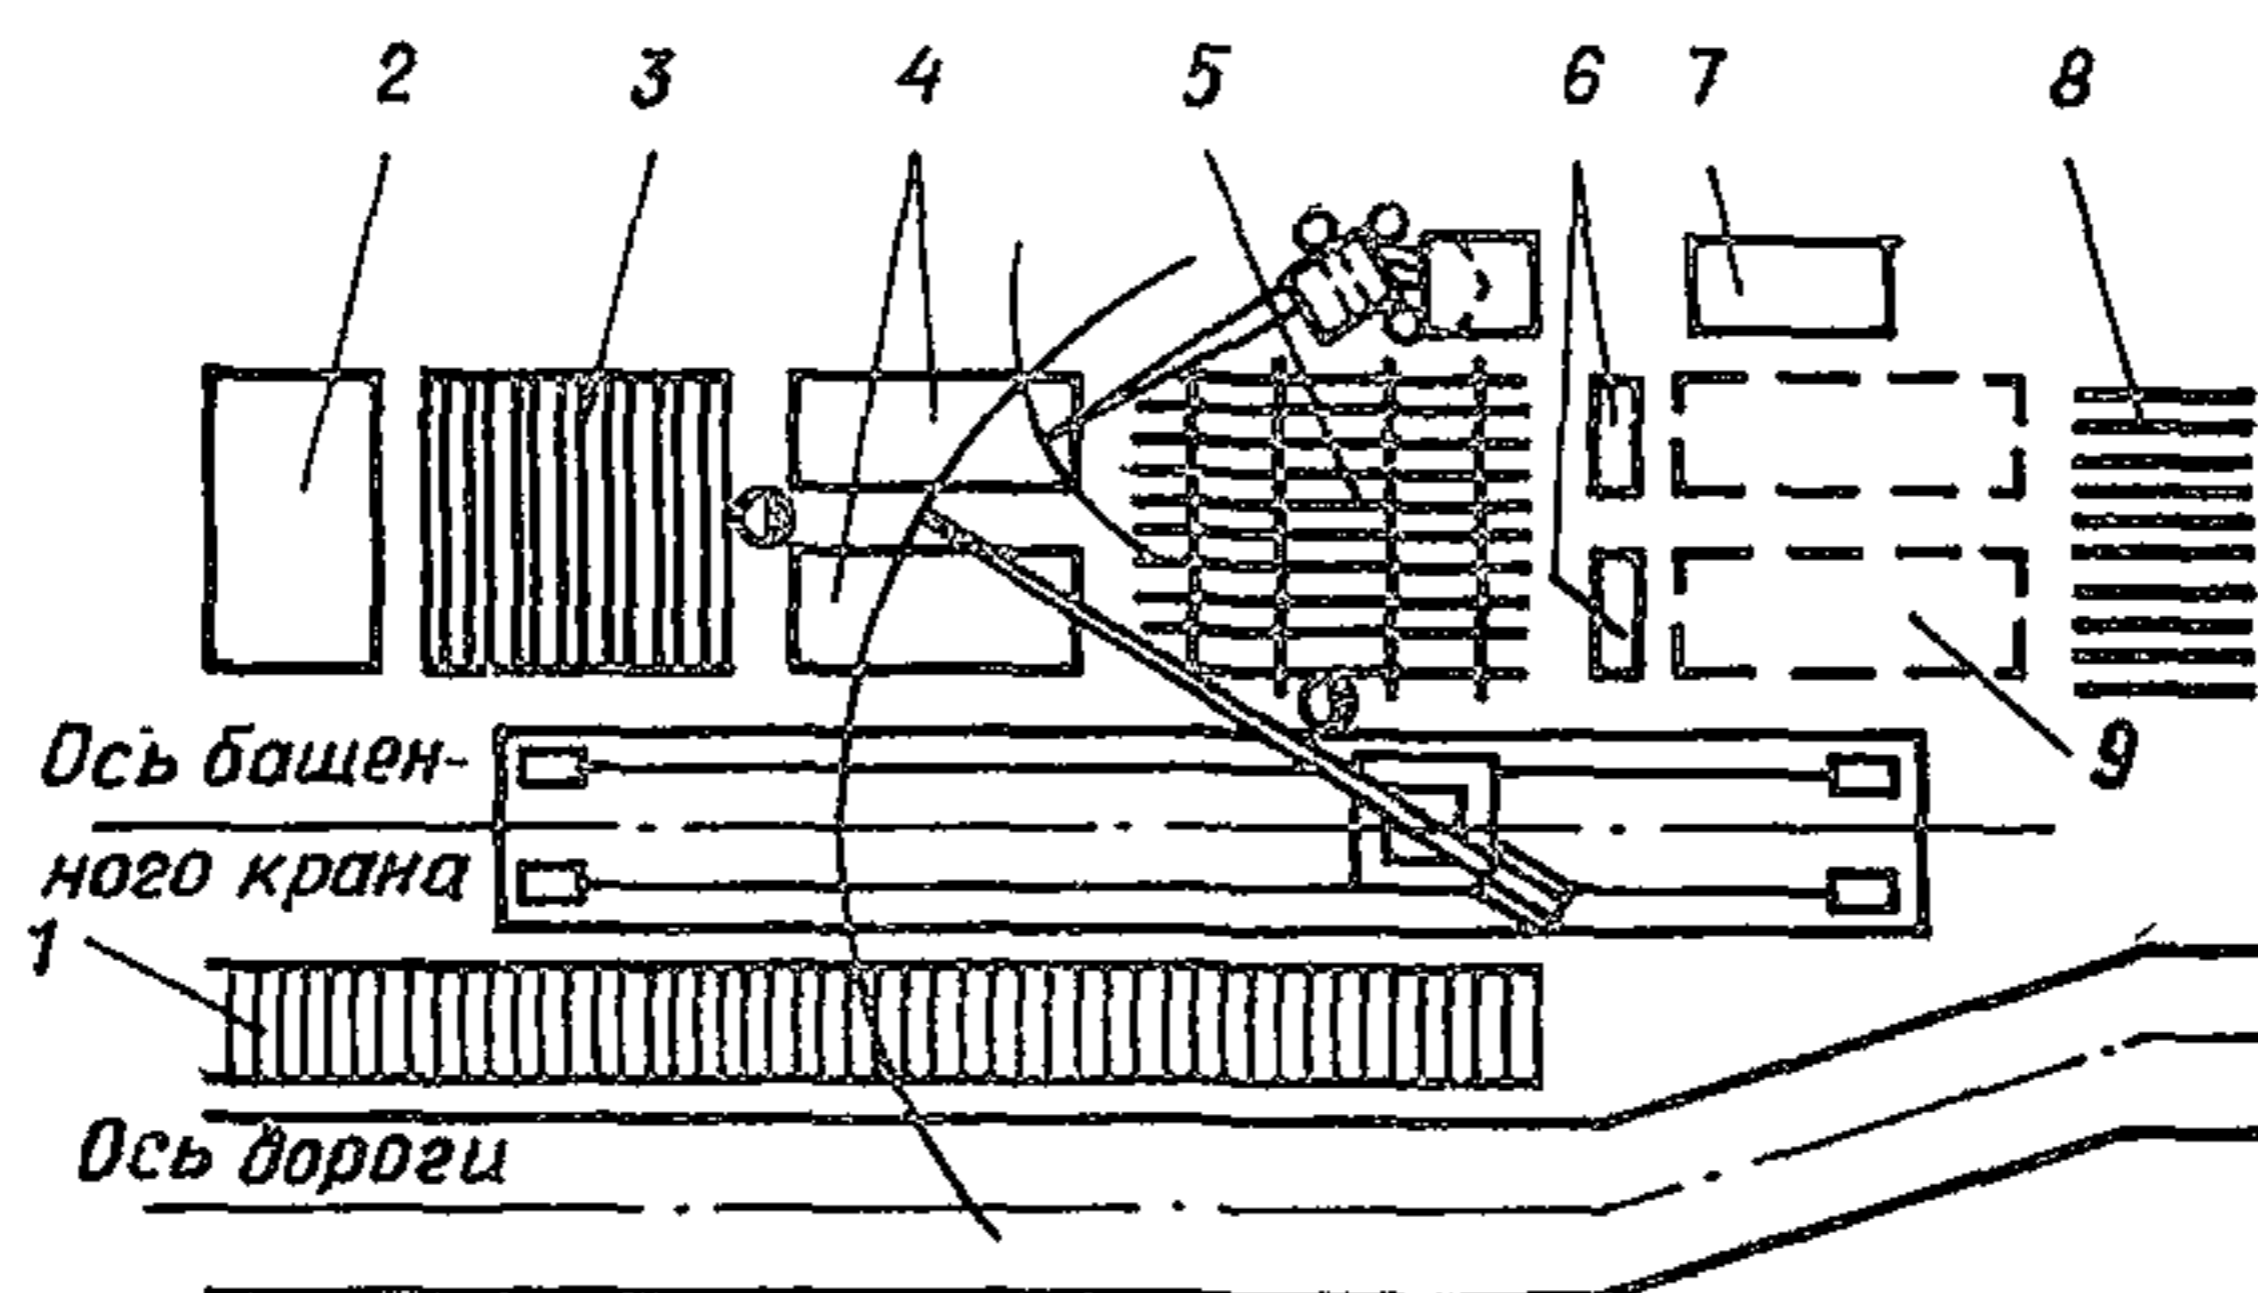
Организация сборно-комплектующей площадки для сборки арматурно-опалубочных блоков
